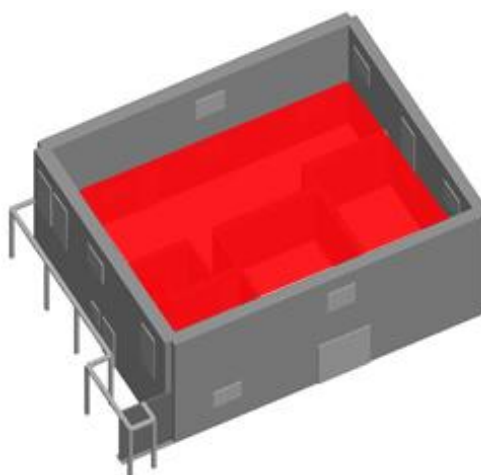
Esquema de rigidificação do pavimento flexível
